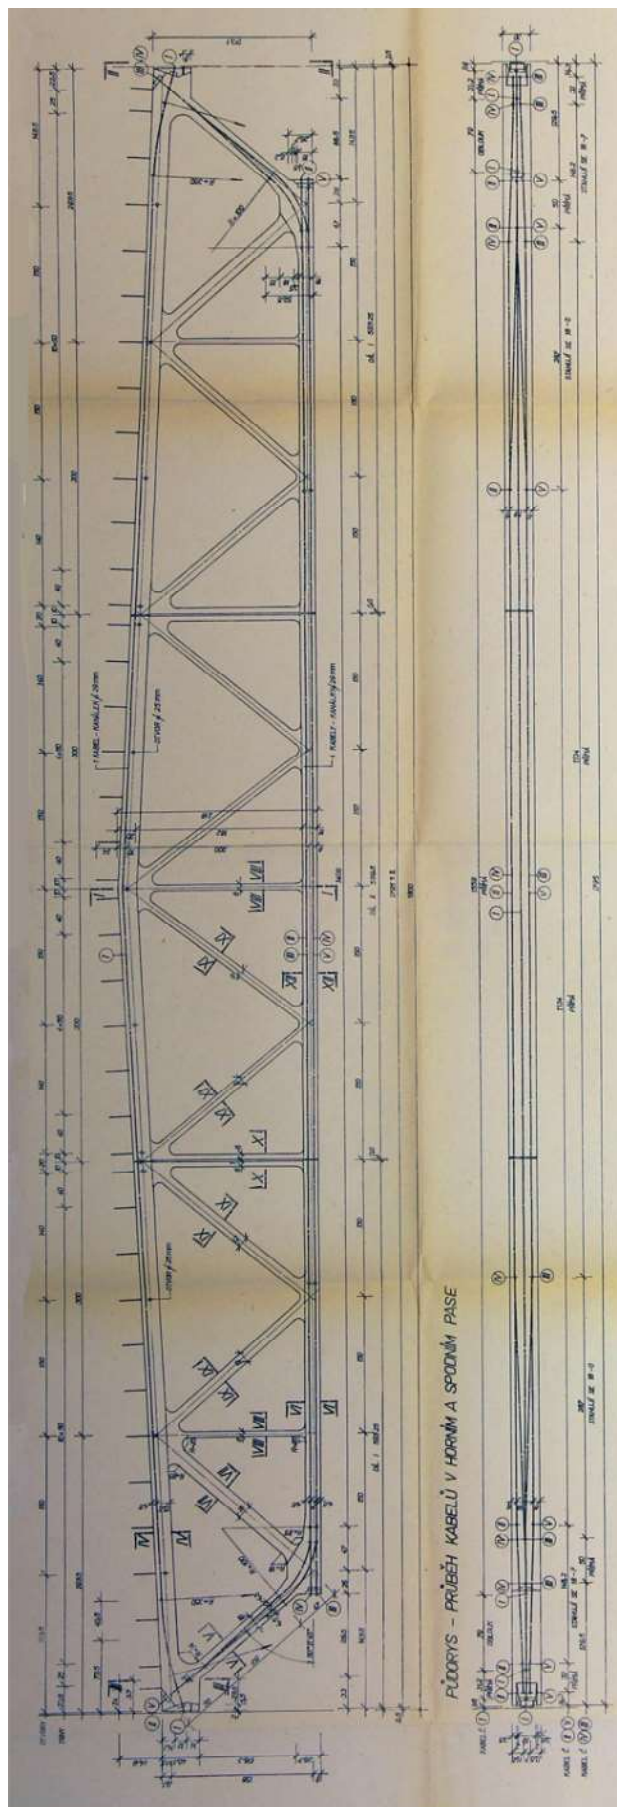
Výpočetní model konstrukce (základní dimenze)
